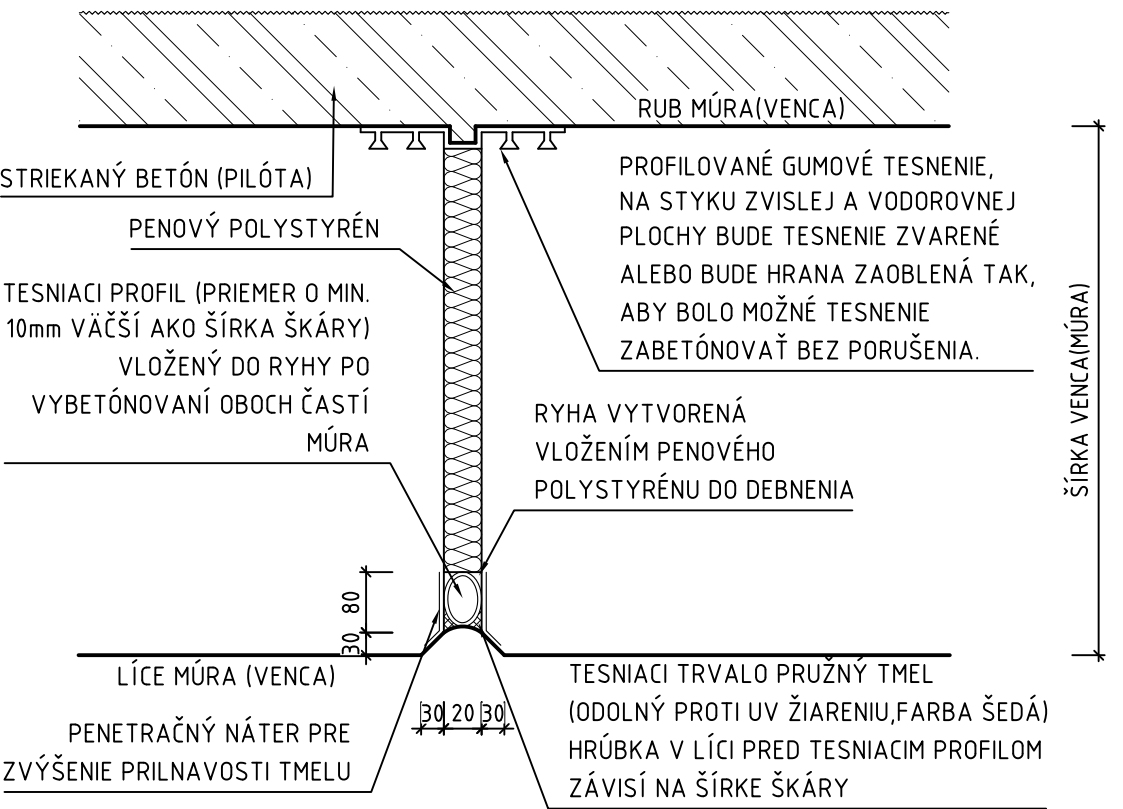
DETAIL PILÓTOVEJ STENY A TORKÉTU
